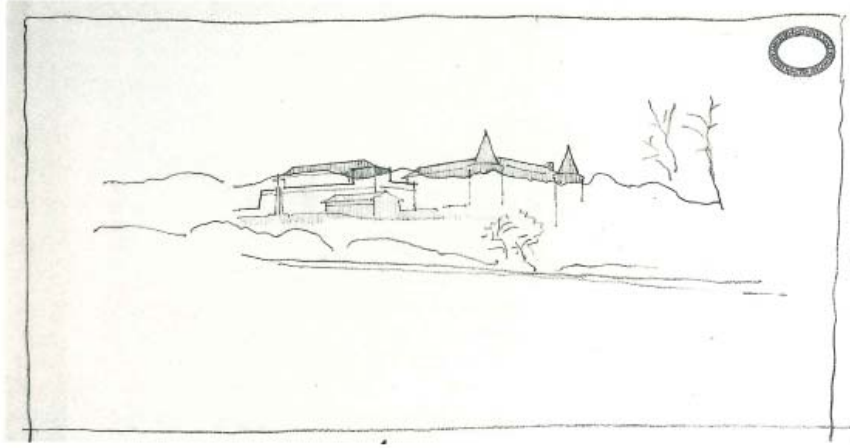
Pianta progetto per Vaals di Van der Laan
